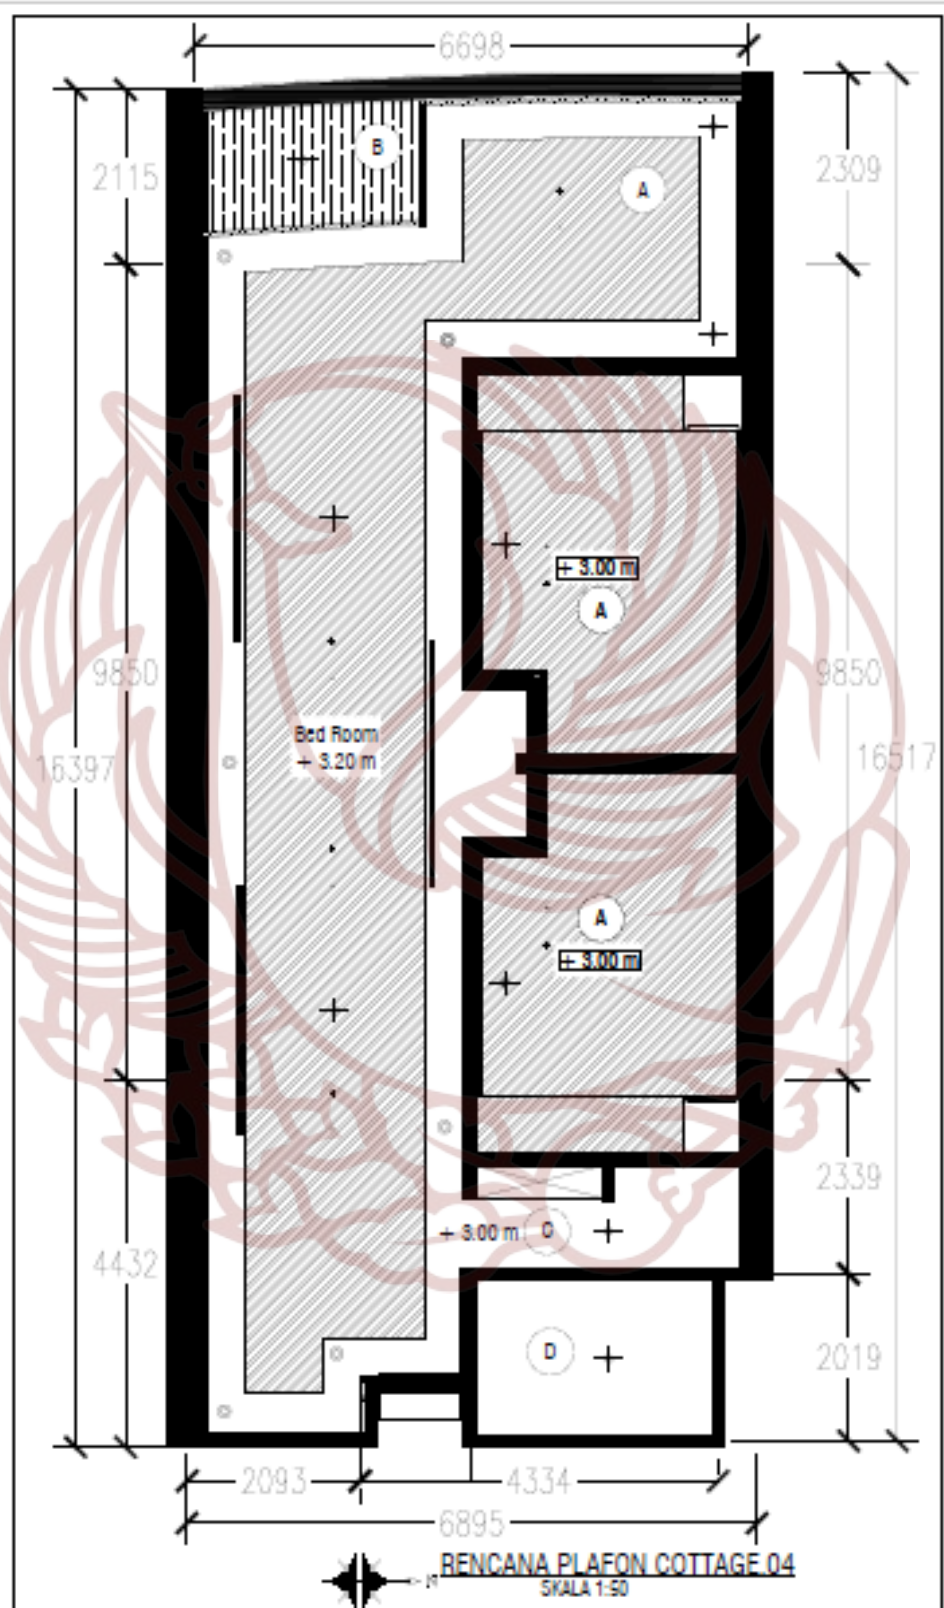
Rencana Ceiling Cottage tipe 1
